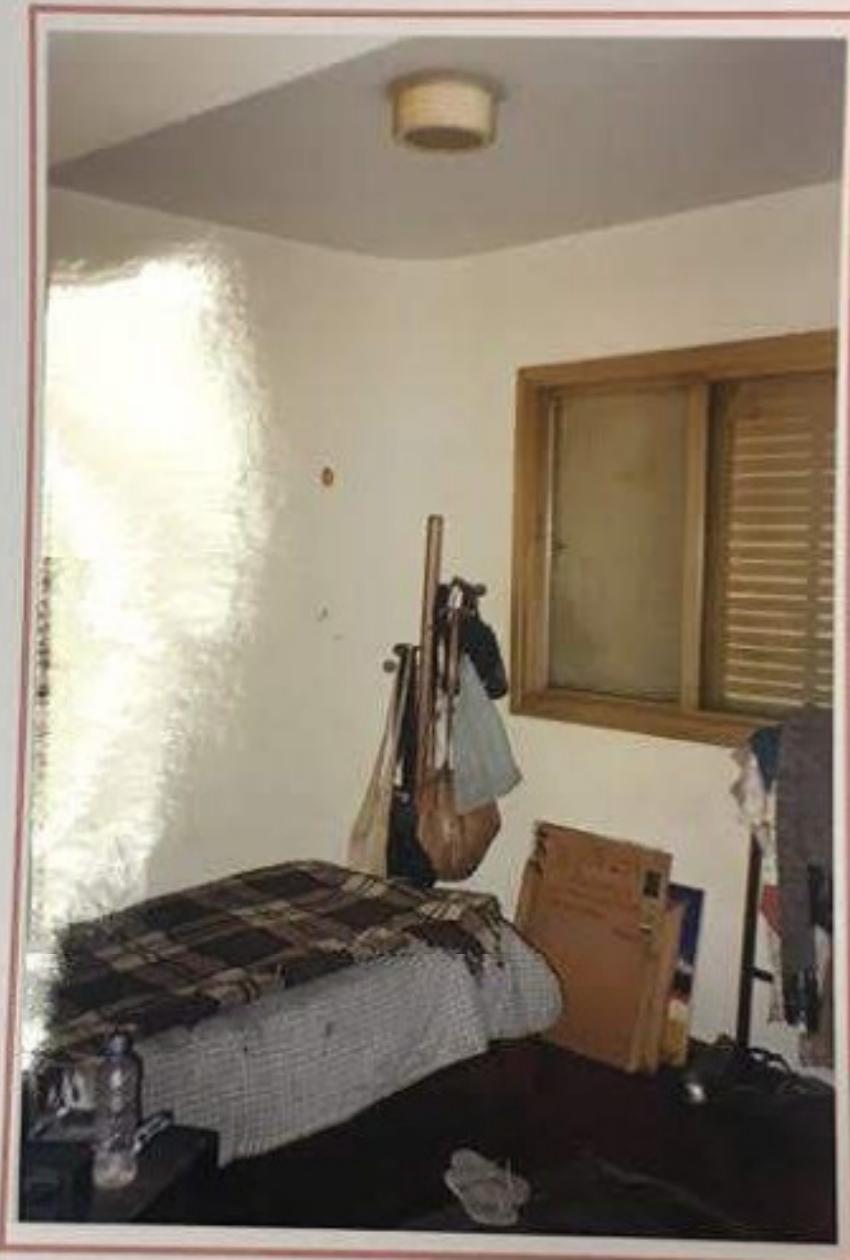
Vista parcial do dormitório, atualmente unificado sem divisão.
